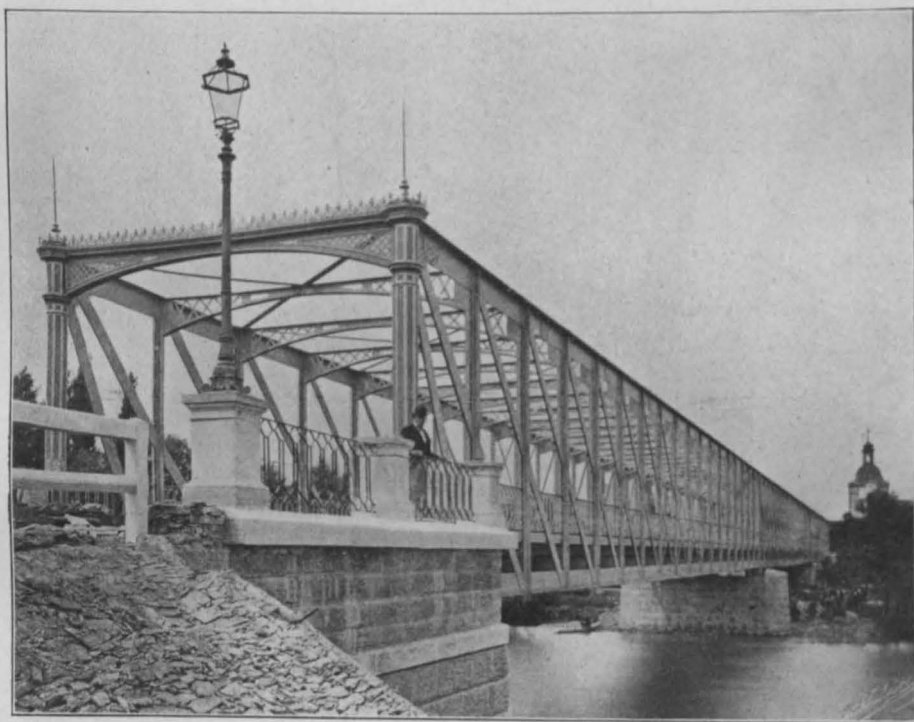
Straßenbrücke über die Elbe in Kolin. Drei Öffnungen von je 58 m Stützweite.
